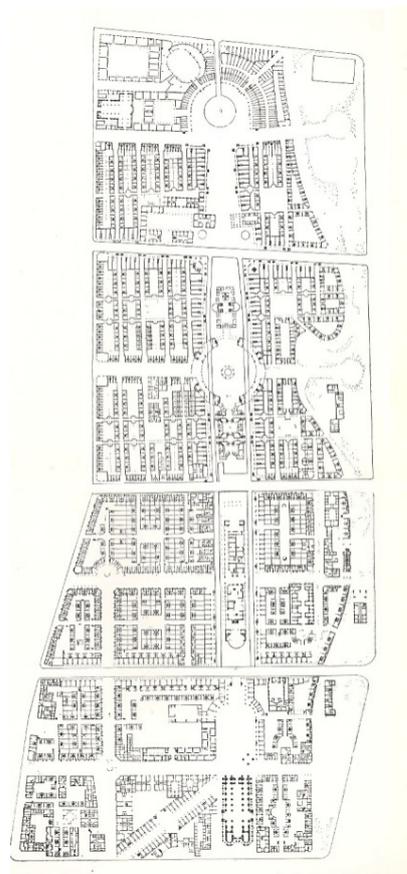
Planta do térreo do projeto urbano para Santiago Poniente. Fonte: CEDLA, 1978.
